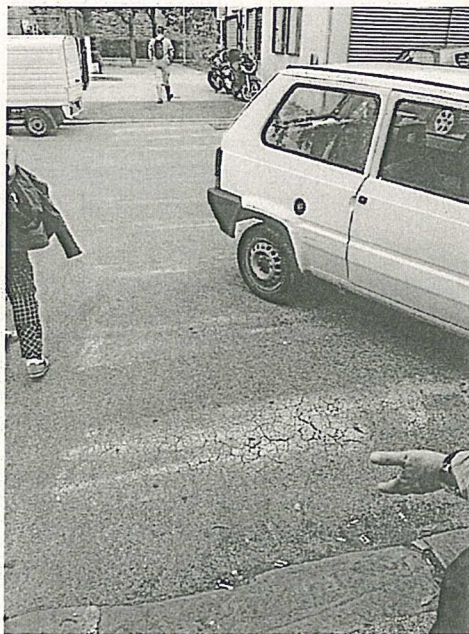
Attraversamenti su L.no Santa Rosa a servizio dell'ASL
